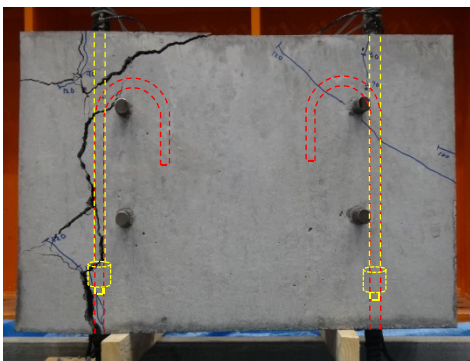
載荷後のひび割れ状況 (試験体 No. 6)
